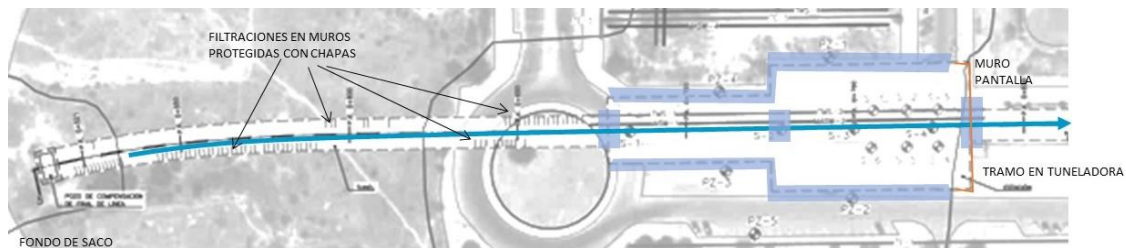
Planta de la estación donde se localizan las zonas de infiltración preferente al sustrato
